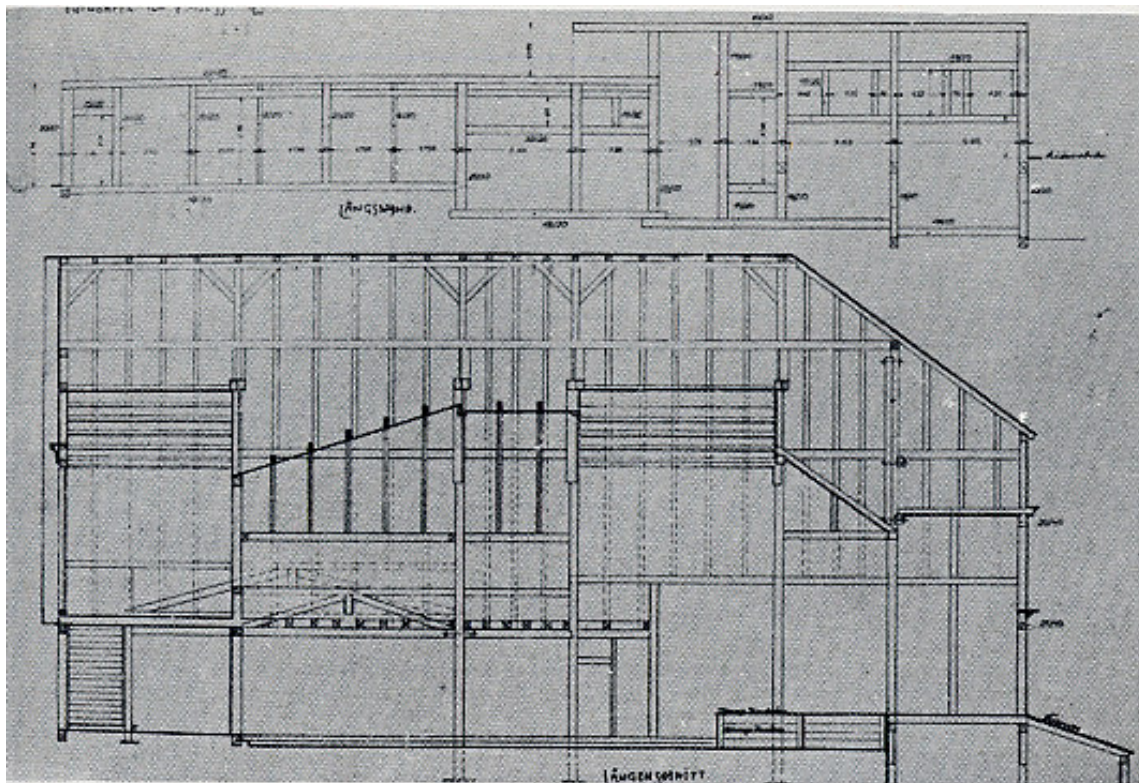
Sezione longitudinale dello Spielhaus.
